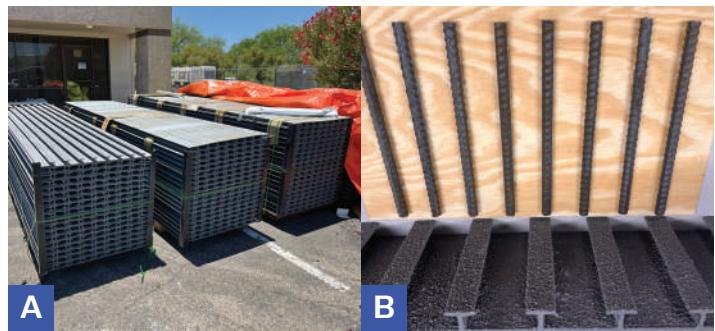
Paneles en T: (a) 3 pies (910 mm) de ancho y 12 o 18 pies (3.7 a 5.5 m) de largo; (b) vista detallada de la superficie recubierta con grano y las barras de refuerzo de acero que proporcionarían una capacidad de tensión equivalente.
